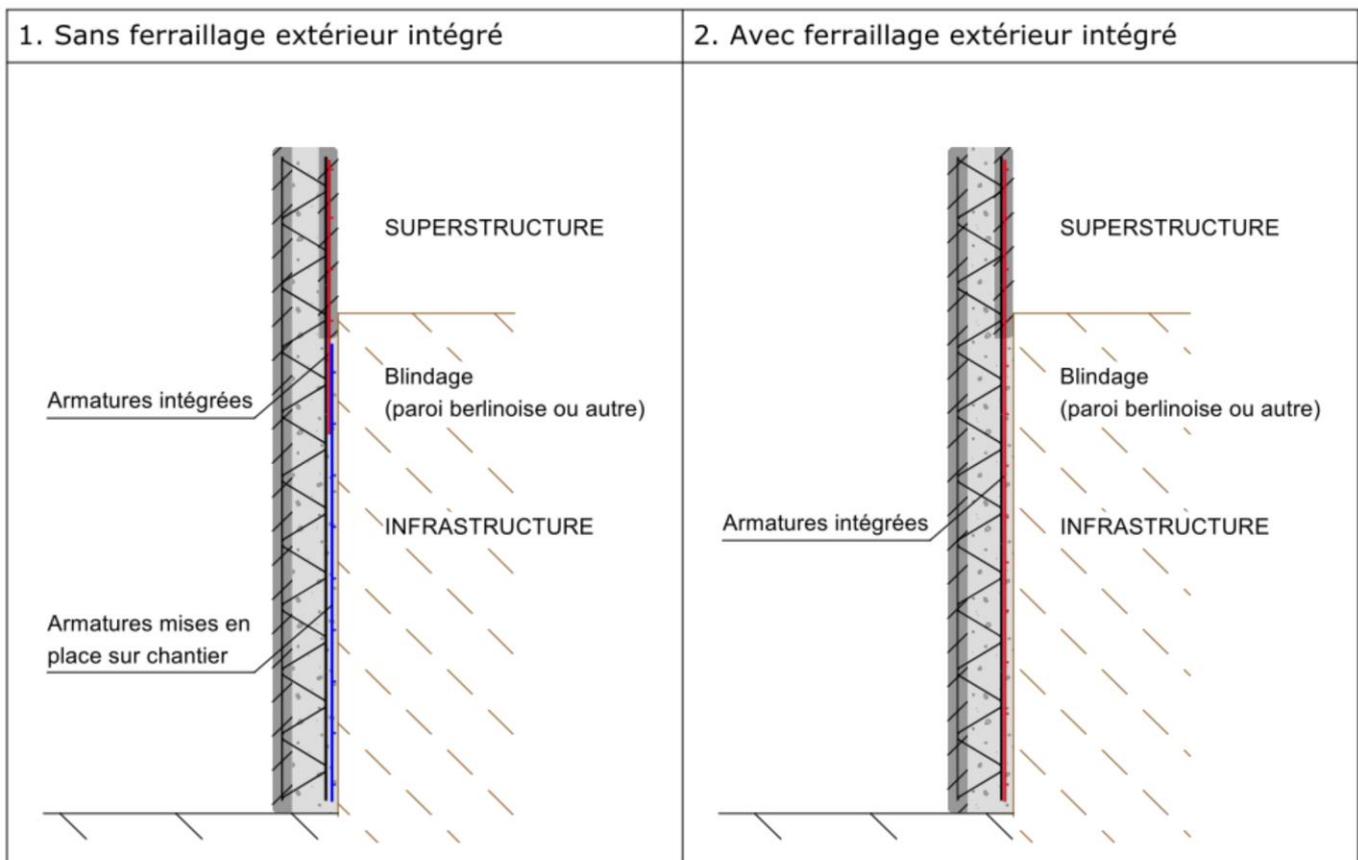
Mur mixte avec ou sans ferrailage en deuxième face
